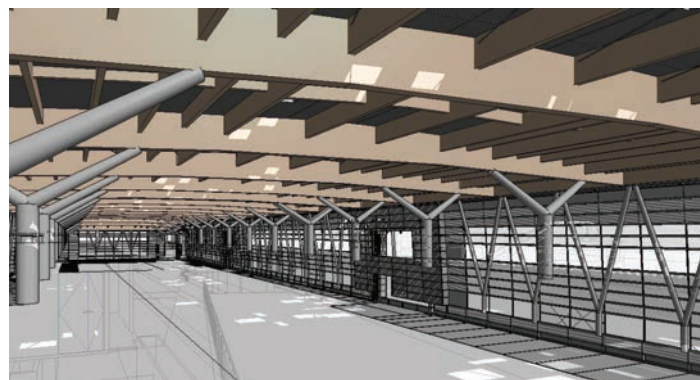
Stralcio modellazione 3D vista interna strutture e facciate in ambiente BIM
